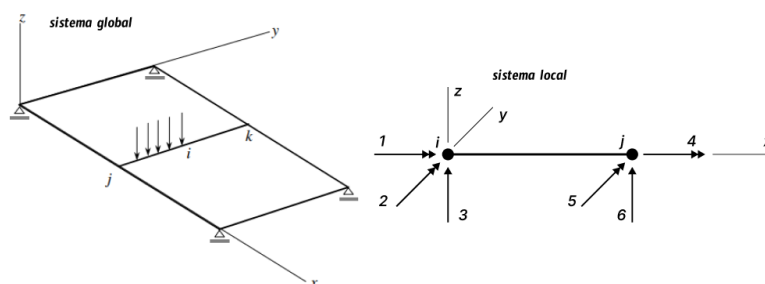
Exemplo de grelha plana e graus de liberdade de um elemento de barra.
